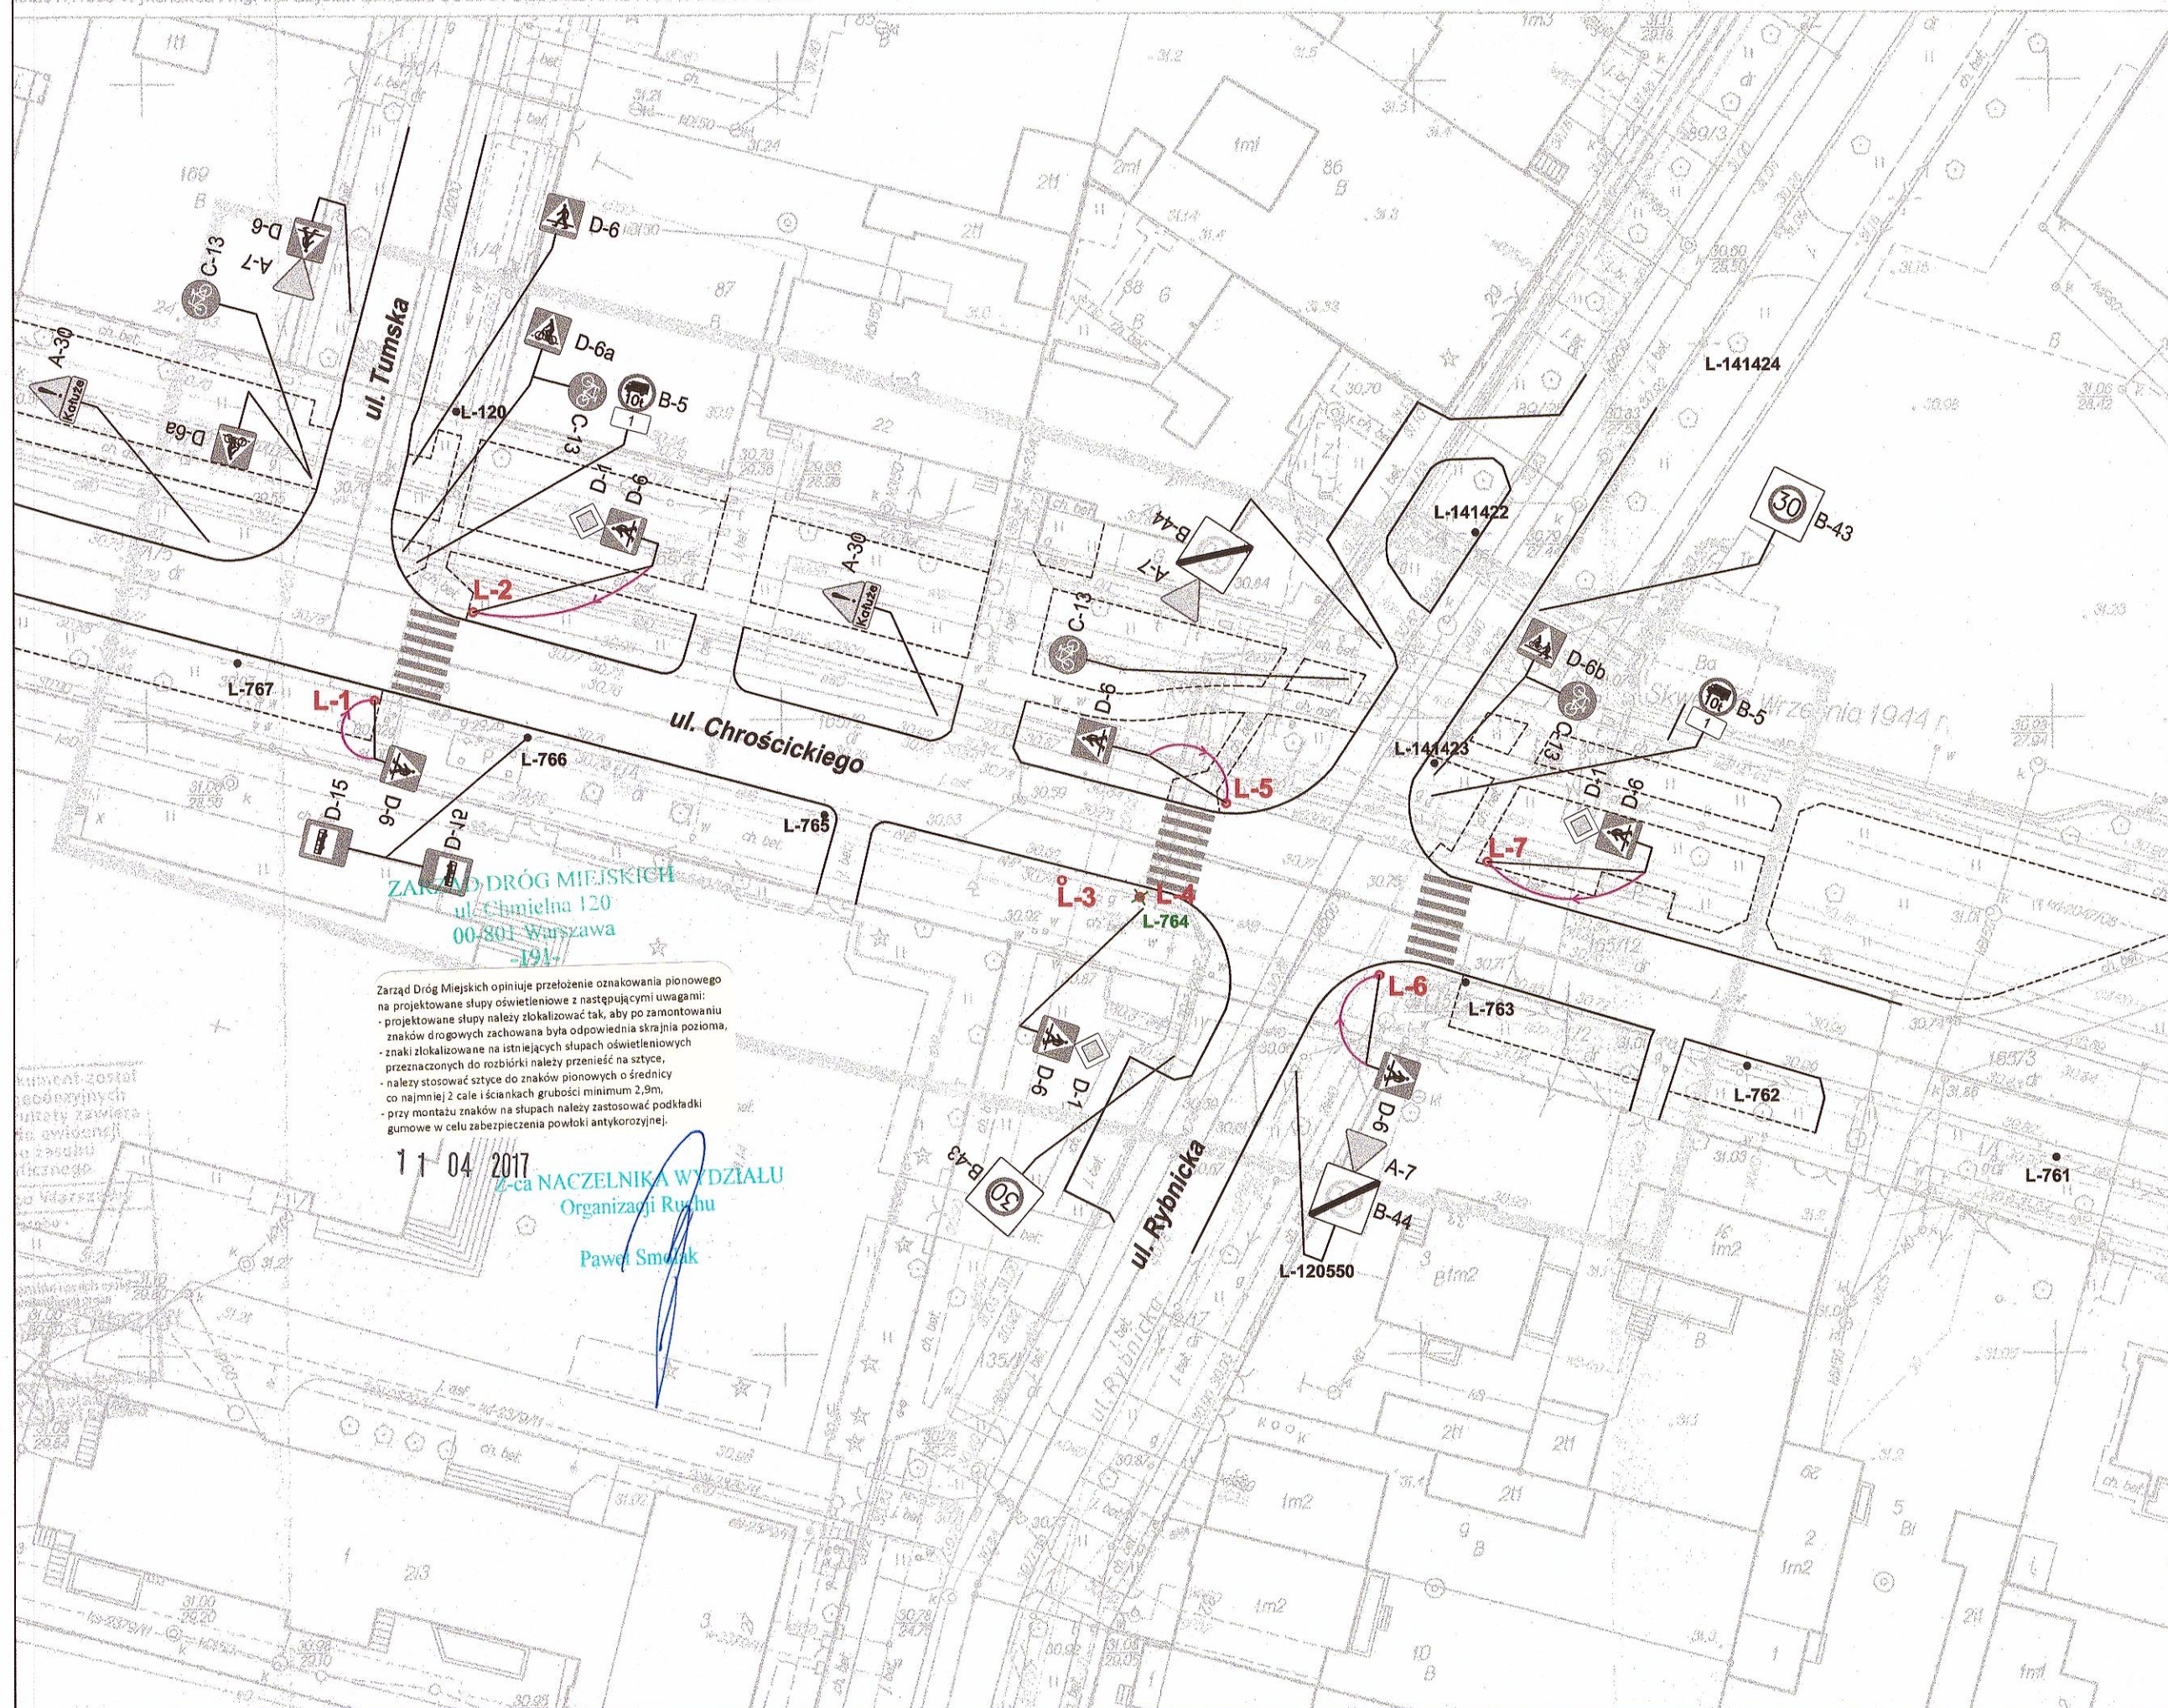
Plan przełożenia oznakowania pionowego
